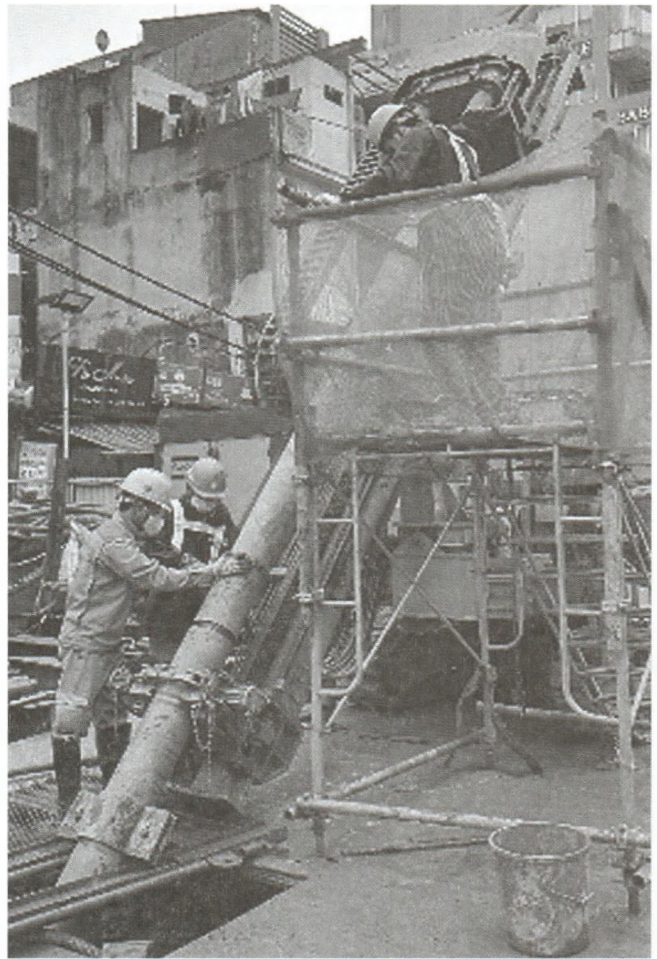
Minh họa khối Jet grouting 3x3 m
